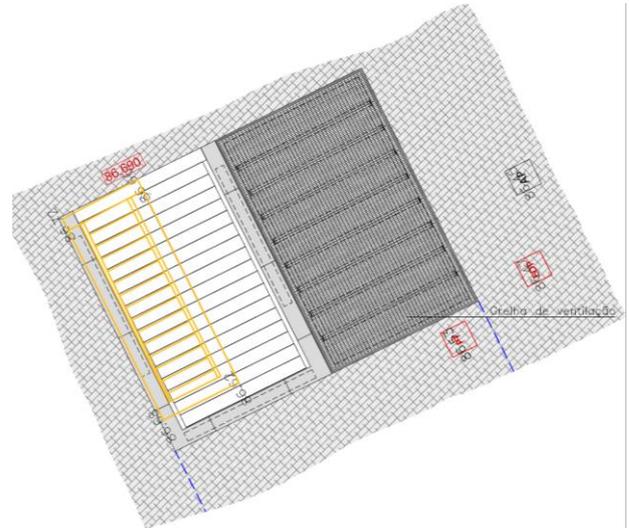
Extrato da Planta de inserção urbana (a amarelo a identificação da escada atual)
